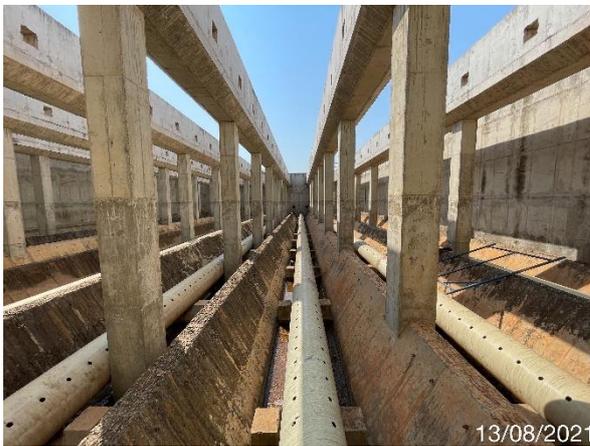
Estruturas divisórias incompletas, presença de fissuras nos pilares e marcas de forma no concreto (Data da imagem: 13/08/2021)
